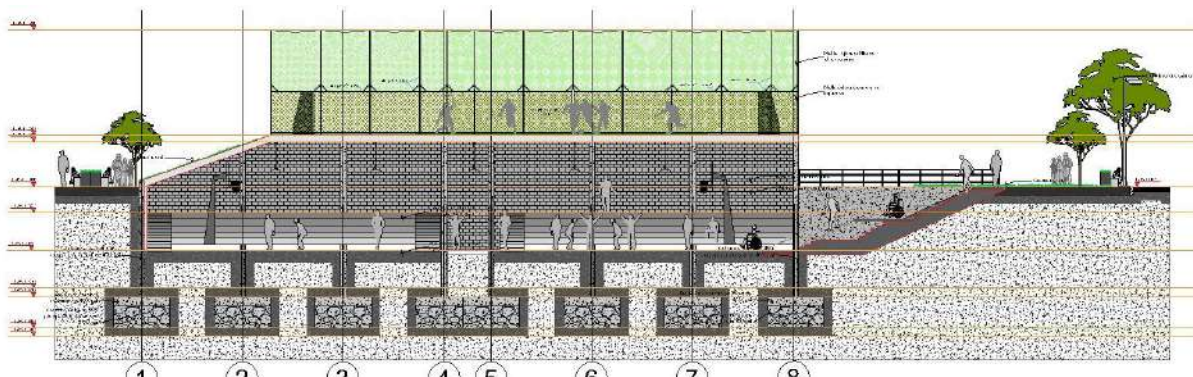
Sección arquitectónica transversal, cancha baloncesto. Fuente: Elaboración propia 2021.
